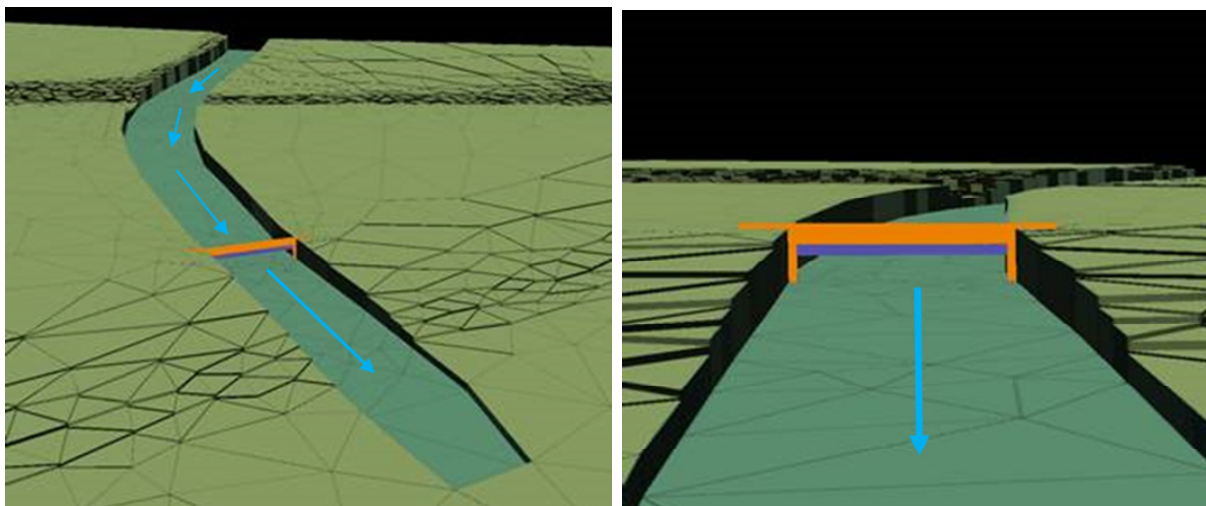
Canal de drenaje a través del Corredor Sur y compuerta anti-retorno situada en la zona próxima al manglar donde se realizara el vertido libre del drenaje.
